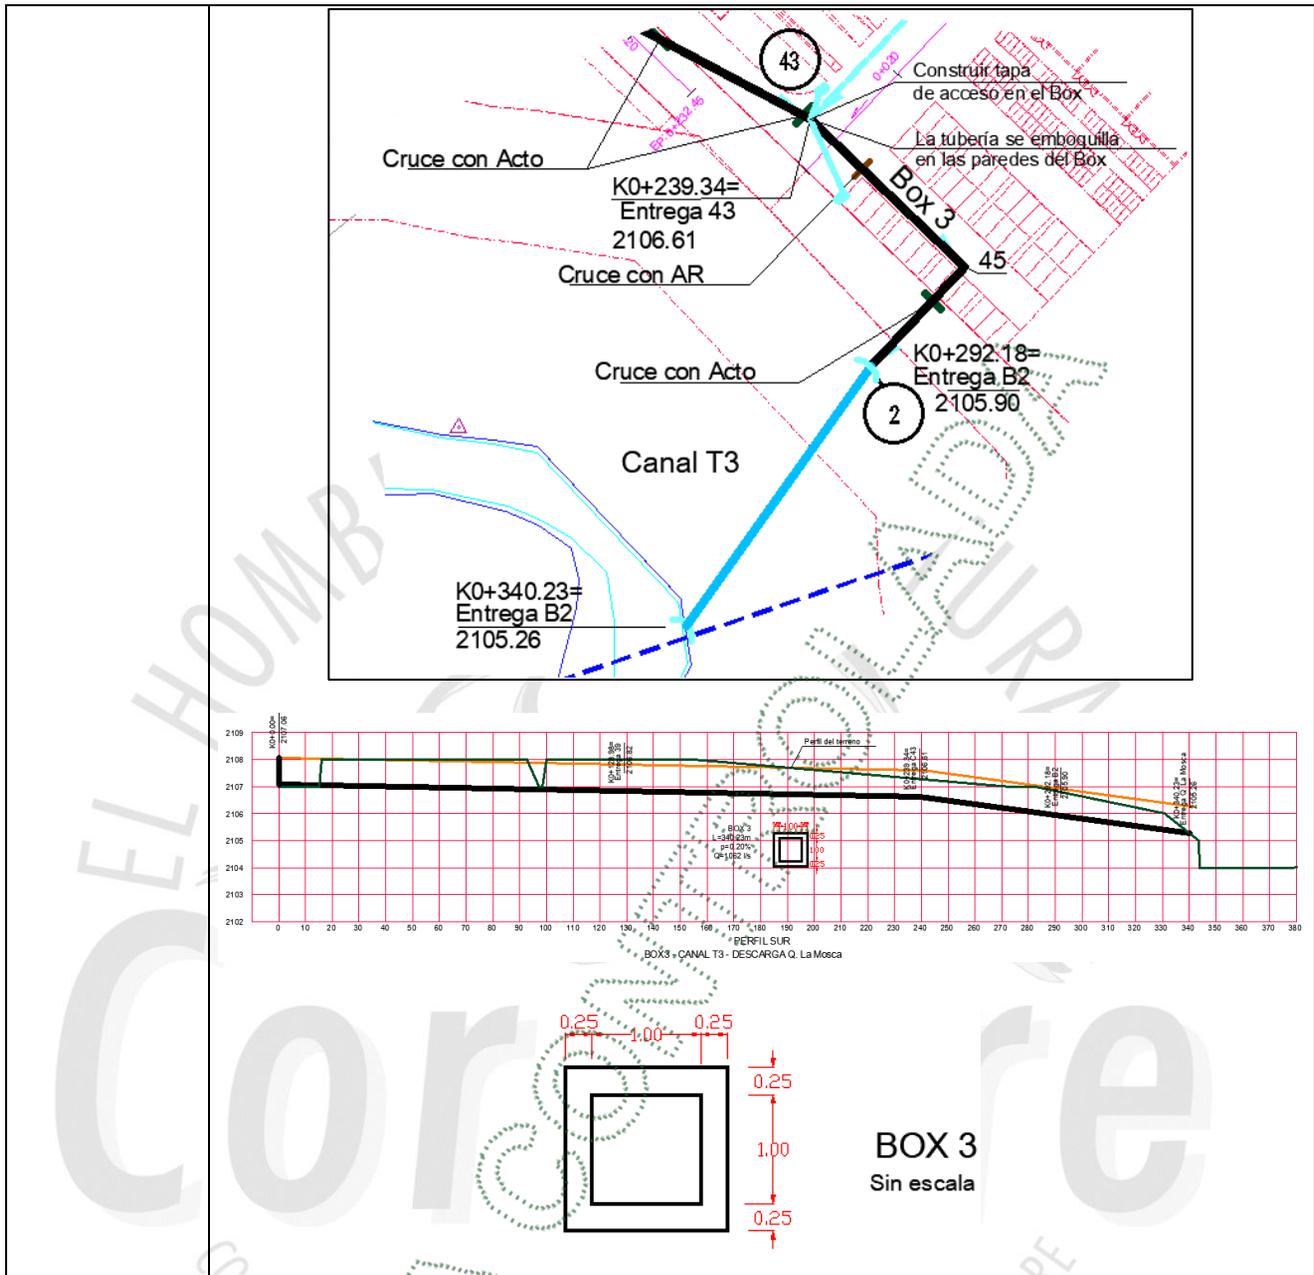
Tipo de la Obra:				Estructura de Descarga V2 (Canal T3)
